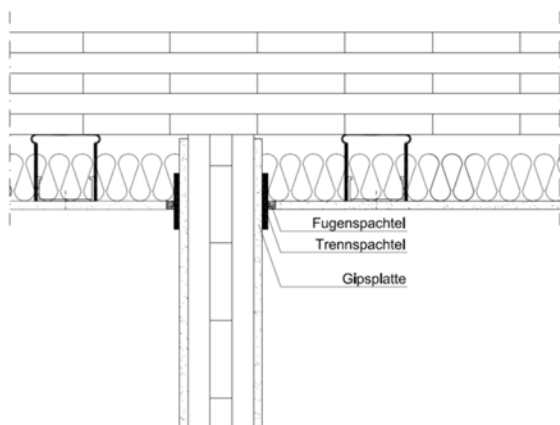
Anschlussdetail einer bekleideten Brettsper Holzwand an eine abgehängte Deckenkonstruktion in Anlehnung an [ÖNORM B 2320]
